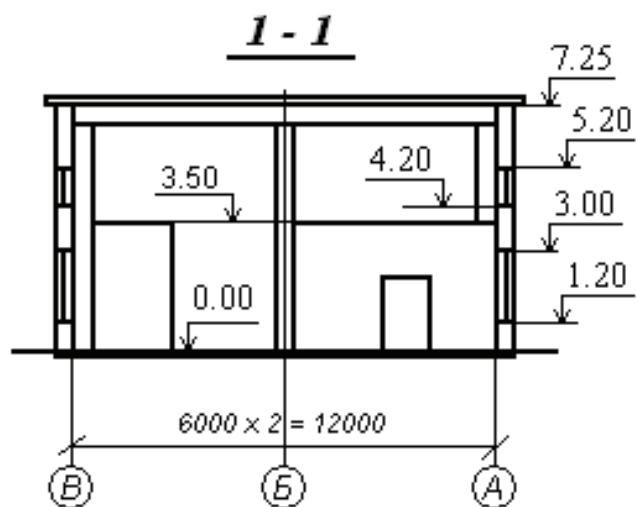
Деревообрабатывающий цех (поперечный разрез)
